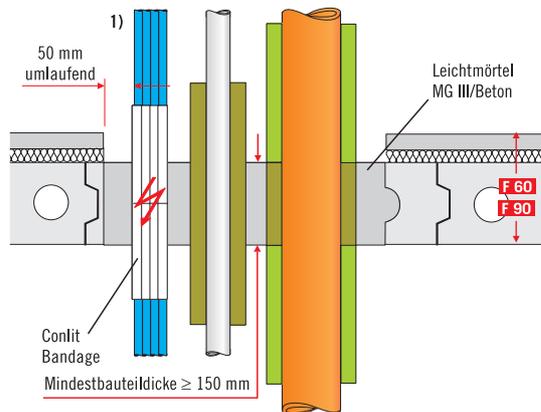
Beispiel zur Abschottung einer Hohlkammerdecke mit Leichtmörtel MG III/Beton
